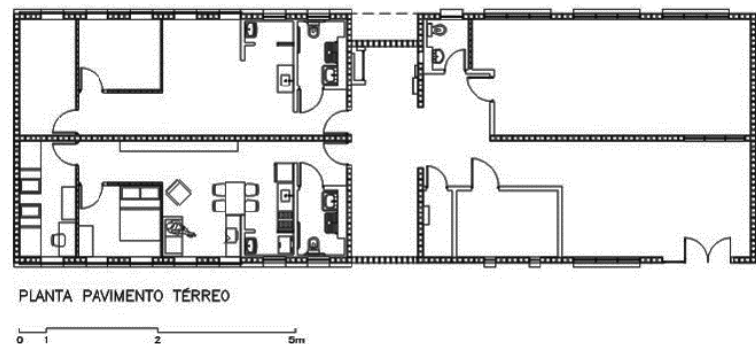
Planta do pavimento térreo constituído por unidades habitacionais, as quais podem possuir ou não as divisões internas por serem paredes não estruturais.
